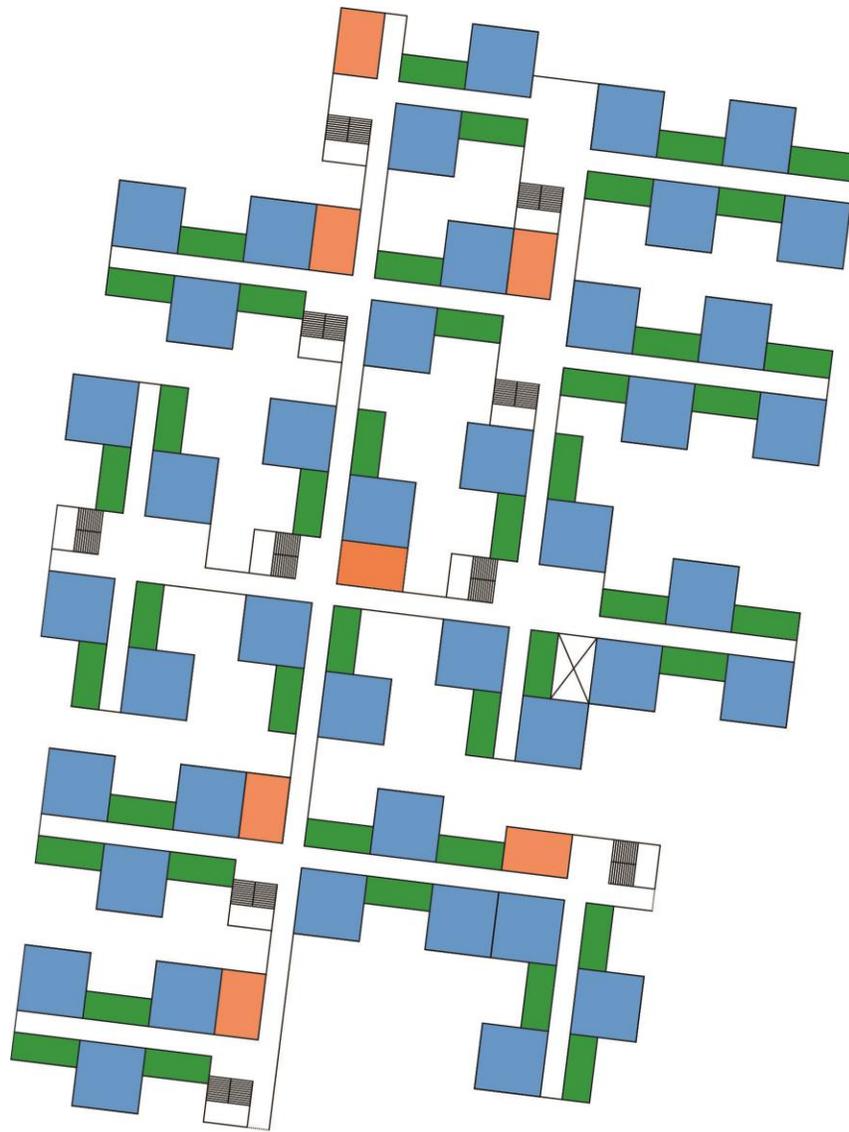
25 Skematik Layout Masa Bangunan Pada Site
